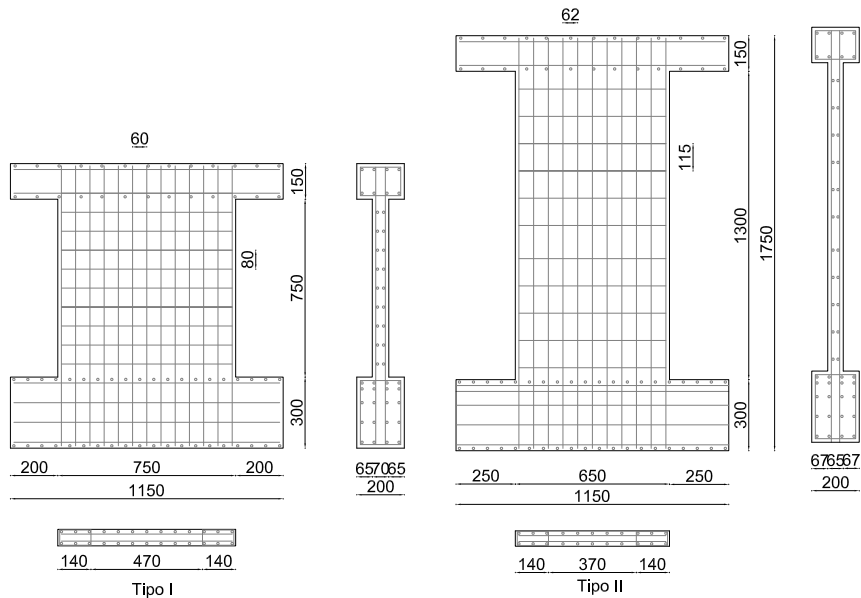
Geometria e detalhes das armaduras das paredes de concreto armado, Lefas et al. (1990)
